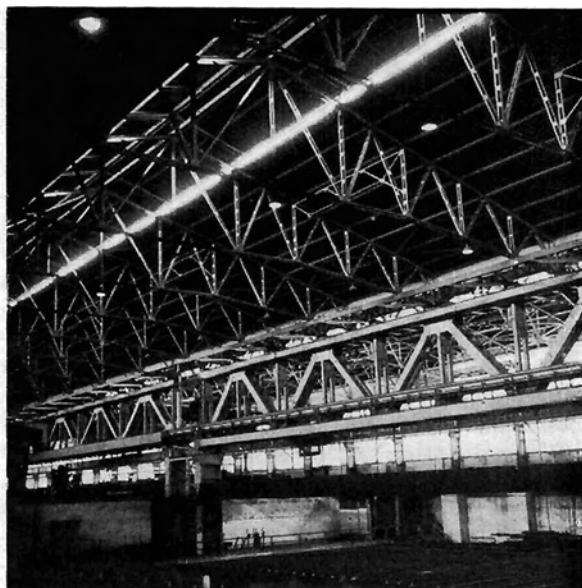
Grobwalzwerkshalle Donawitz. Im Vordergrund zwei 40 und 65 m lange Brückenträger
